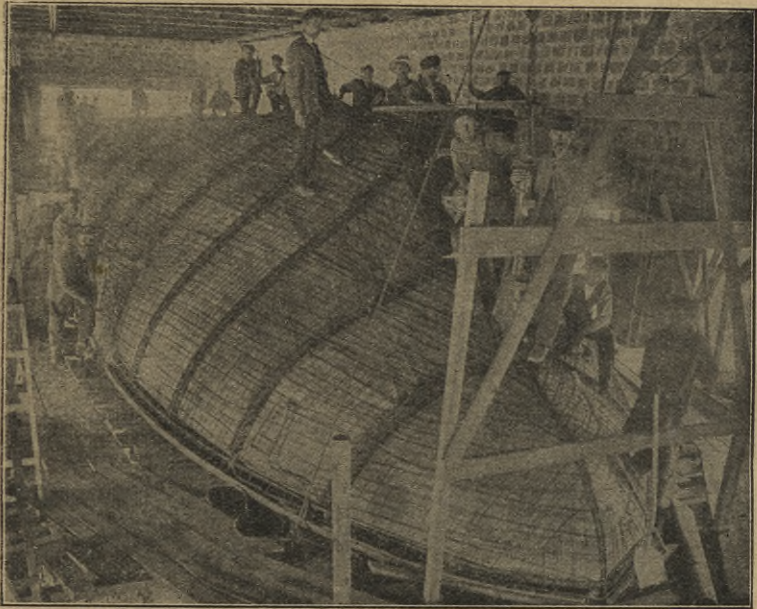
Eisenbetonschiff, Bauweise Alfsen, während des Baues.
